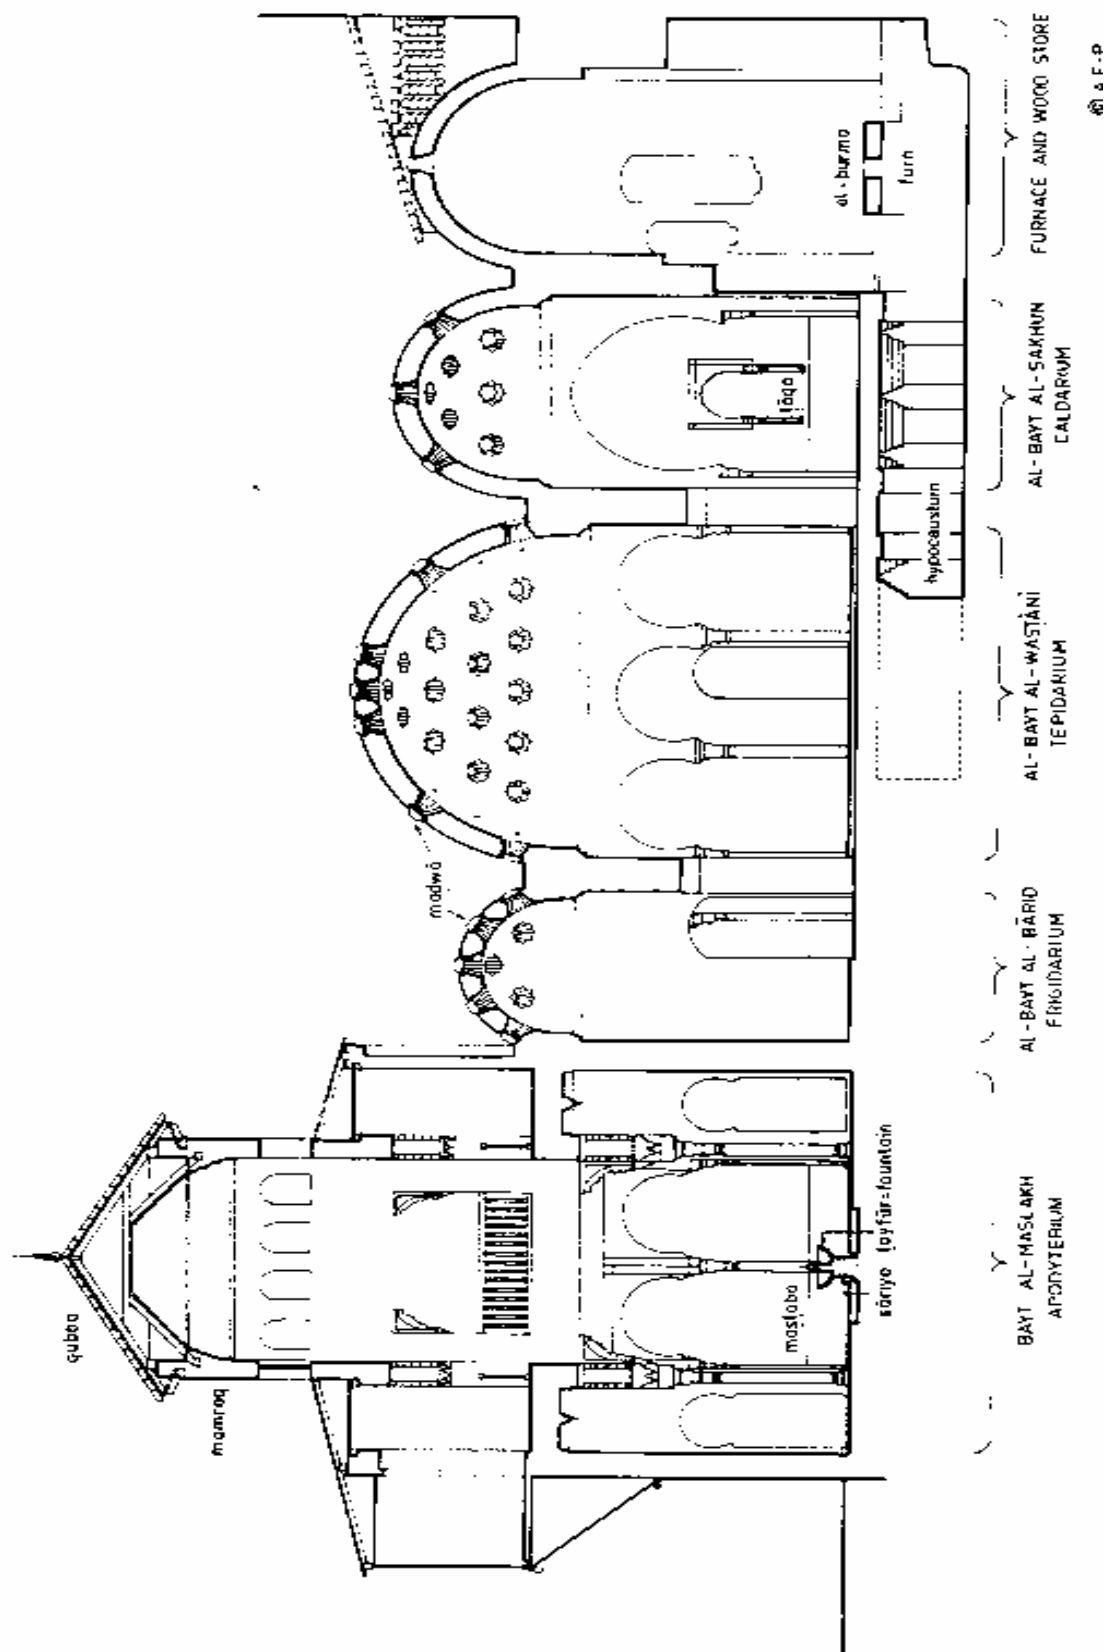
Sección N-S de los Baños de Comares con las distintas secciones (Fdez. Puertas, The Alhambra).
